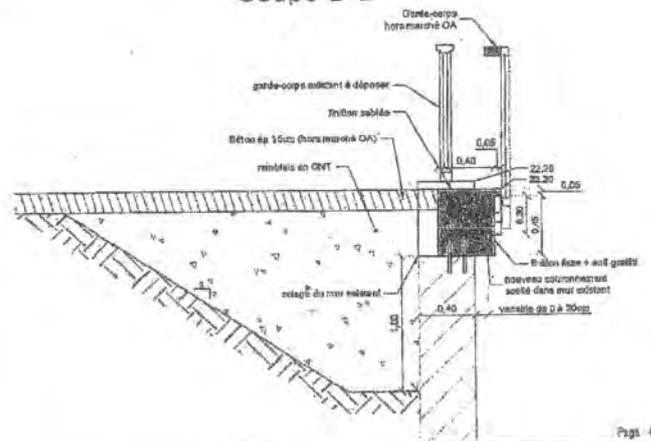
DETAILS SOUTÈNEMENT SUR QUAI EXISTANT
